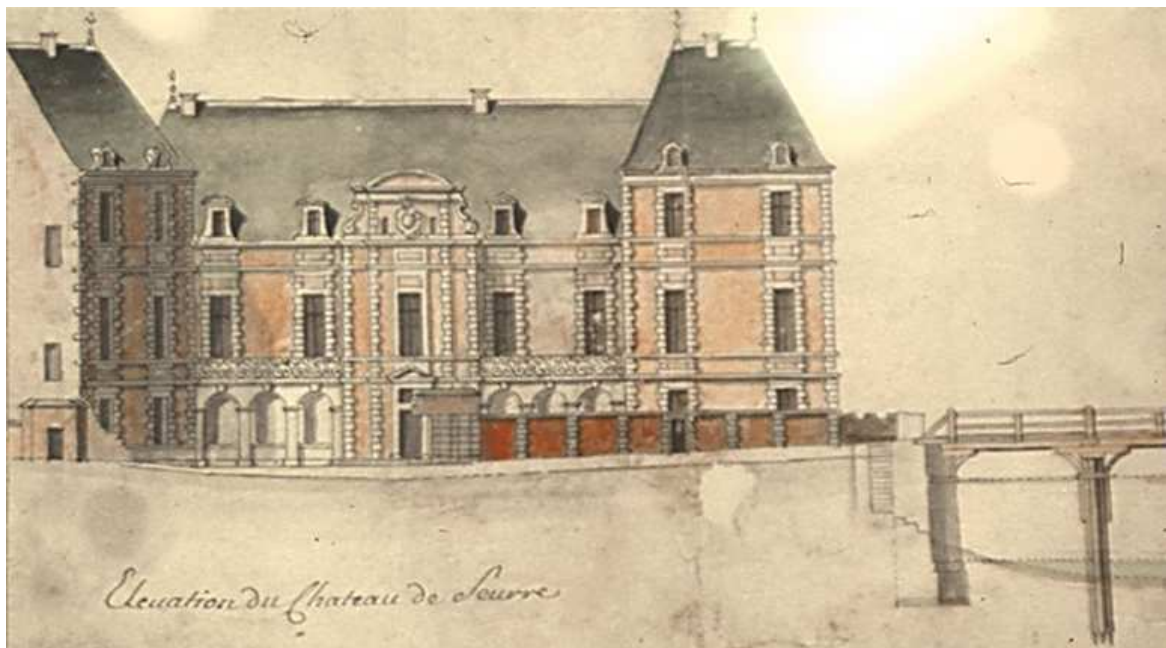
Façade du château de Seurre en 1730 (Projet de reconstruction du pont de Seurre, ADCO, C4200 ; photo d'Hervé Mouillebouche)
